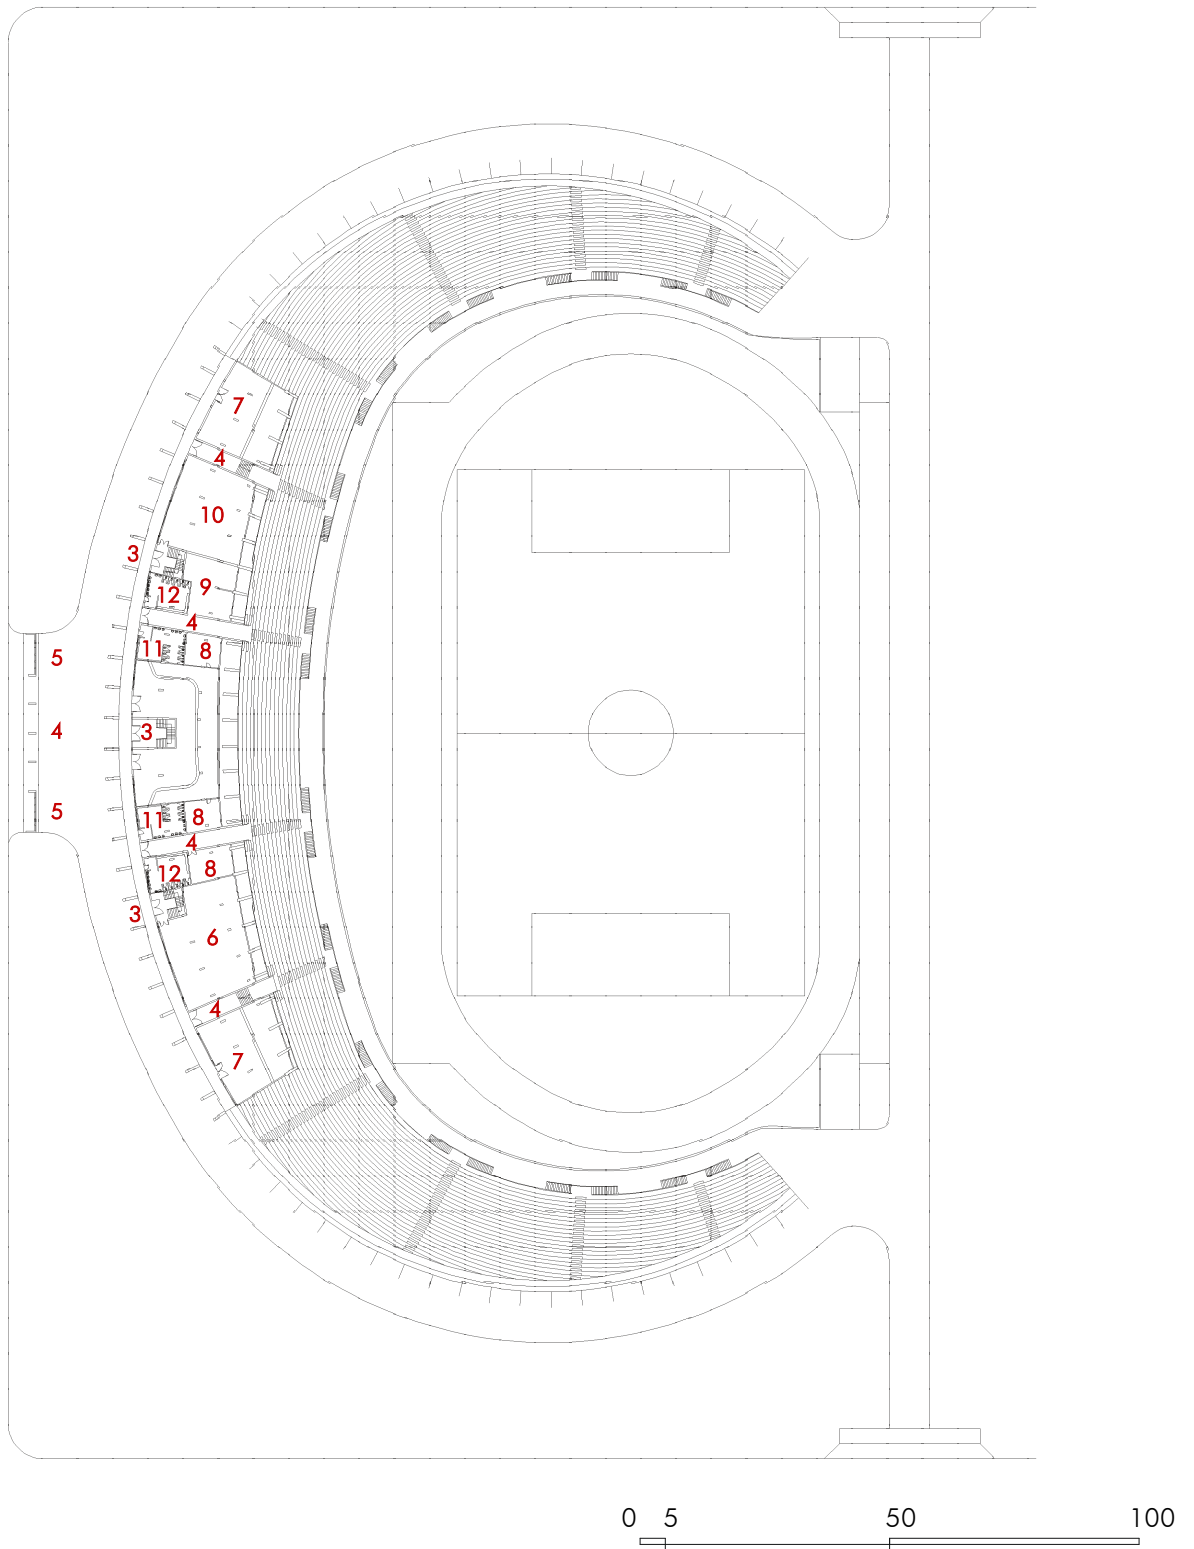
Planta pavimento térreo: Estádio (segue legenda da página 119)
